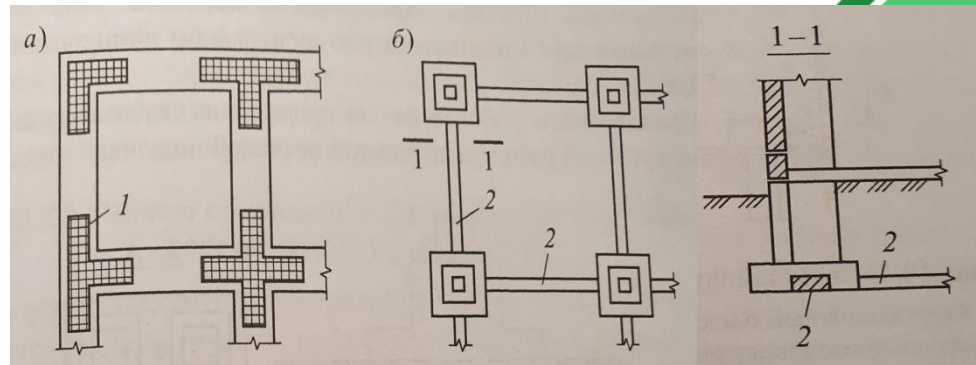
Конструкции фундаментов для сейсмических воздействий:
